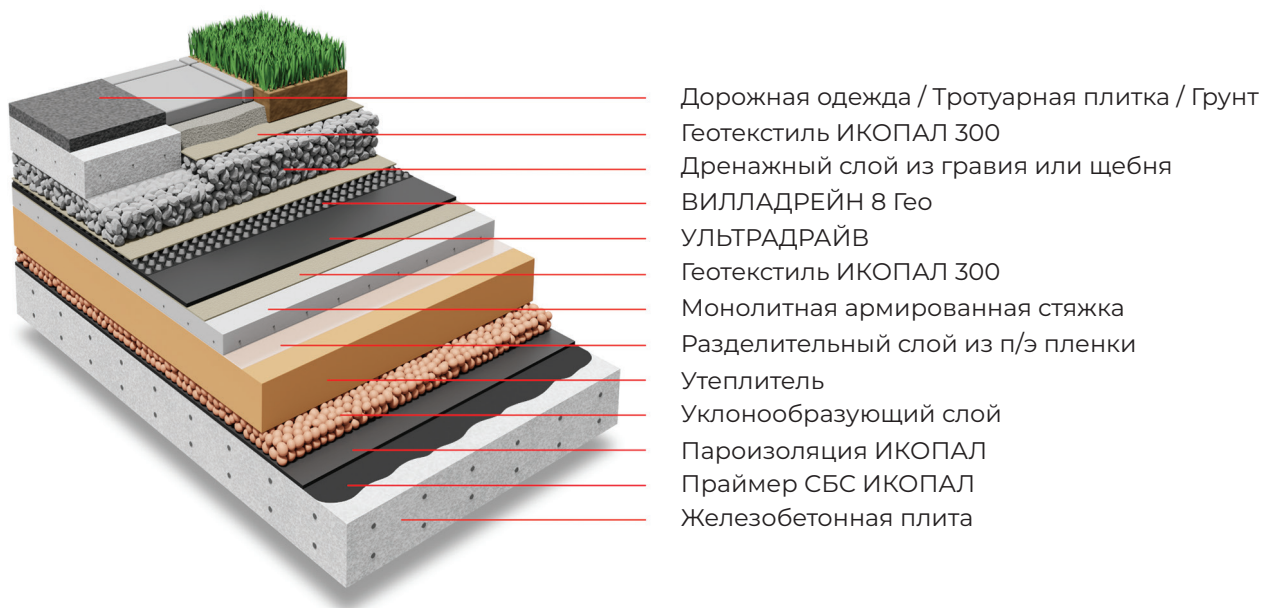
Вариант традиционной эксплуатируемой кровли с однослойным кровельным ковром
